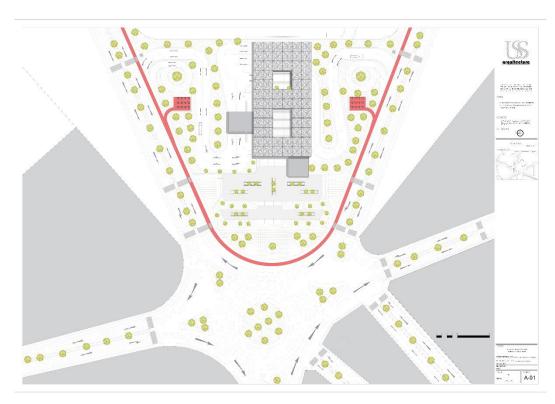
Master Plan-Proyecto Estación intermodal. Elaboración propia
